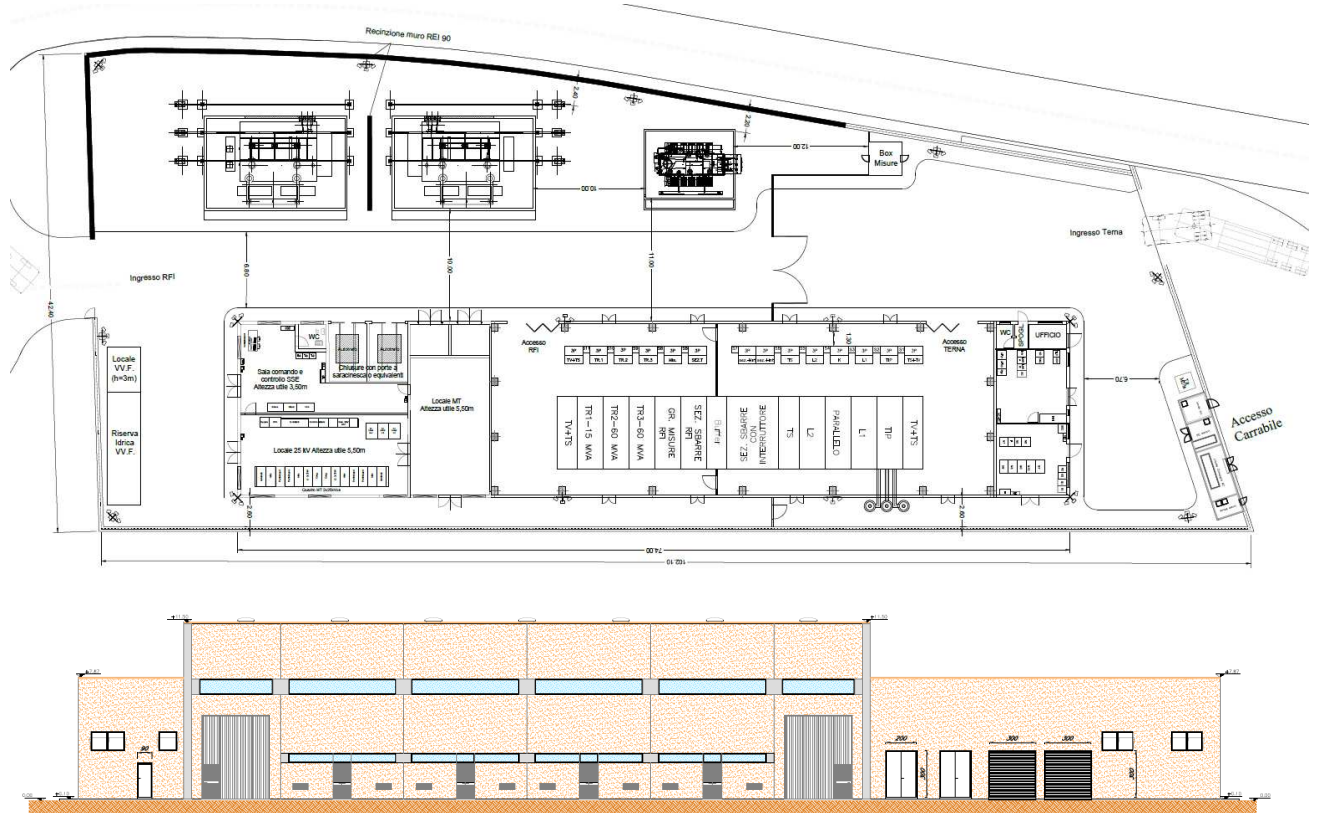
Pianta e prospetto Fabbricati SSE Ponte Gardena
